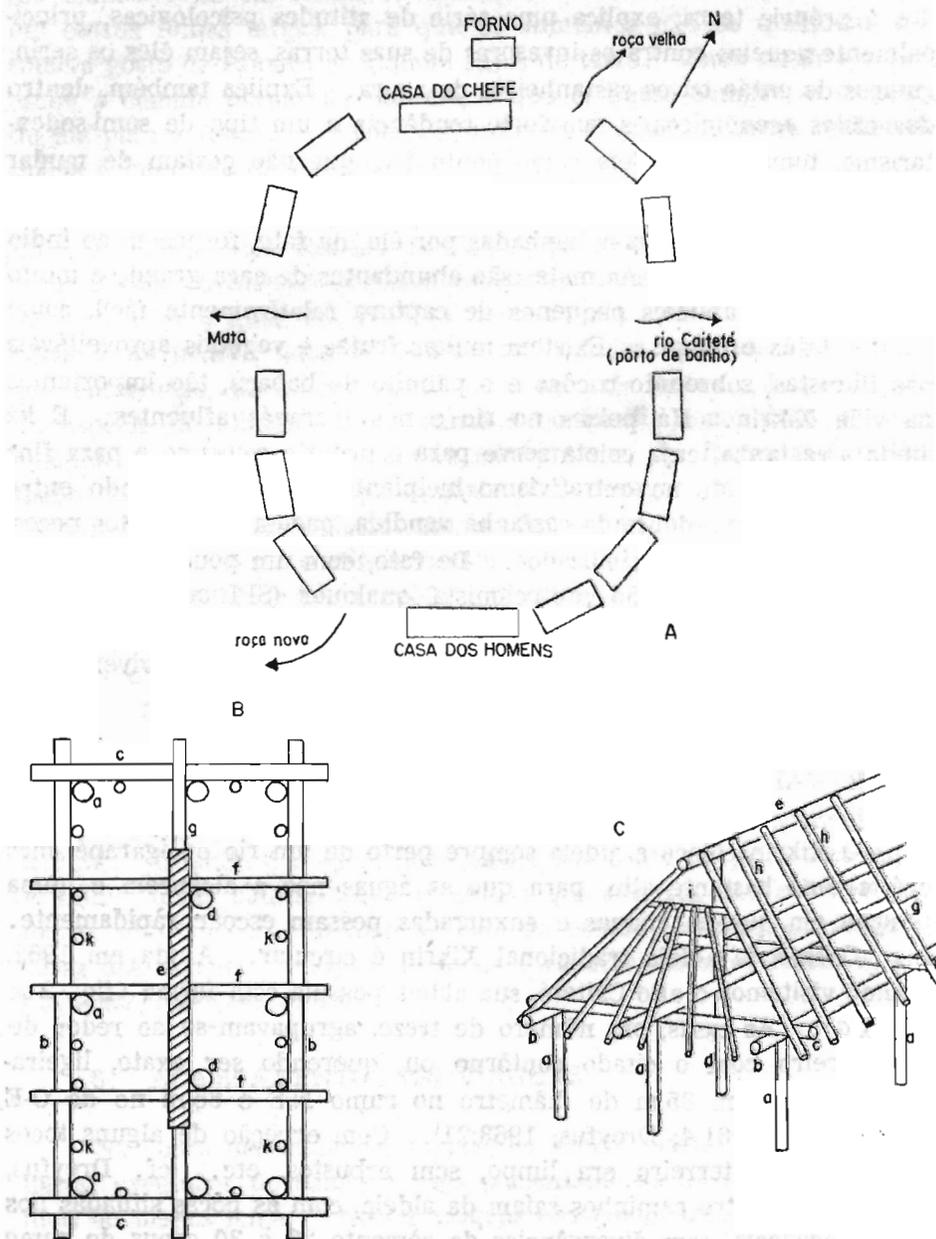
Aldeia e casa Xikrín. a) Croquis da aldeia Xikrín do tipo tradicional; b) Planta-baixa de uma casa Xikrín; c) Detalhes de construção da casa Xikrín.
